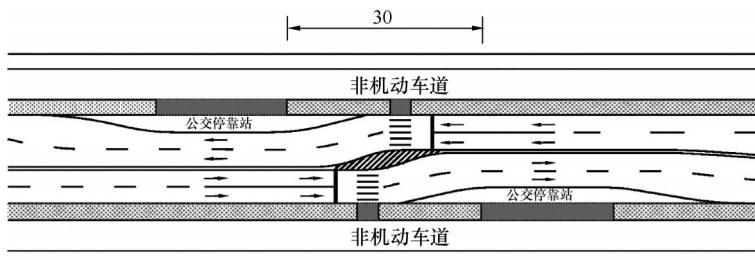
上下行对应公交站位背向错开（单位：m）
